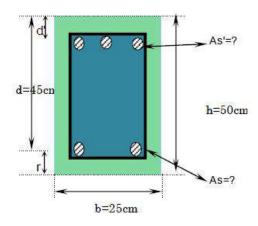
Pre dimensionamiento de viga 0.25x0.50 m
